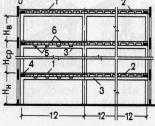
Полный сборный железобетонный каркас многоэтажного промышленного здания с перекрытиями балочного типа
